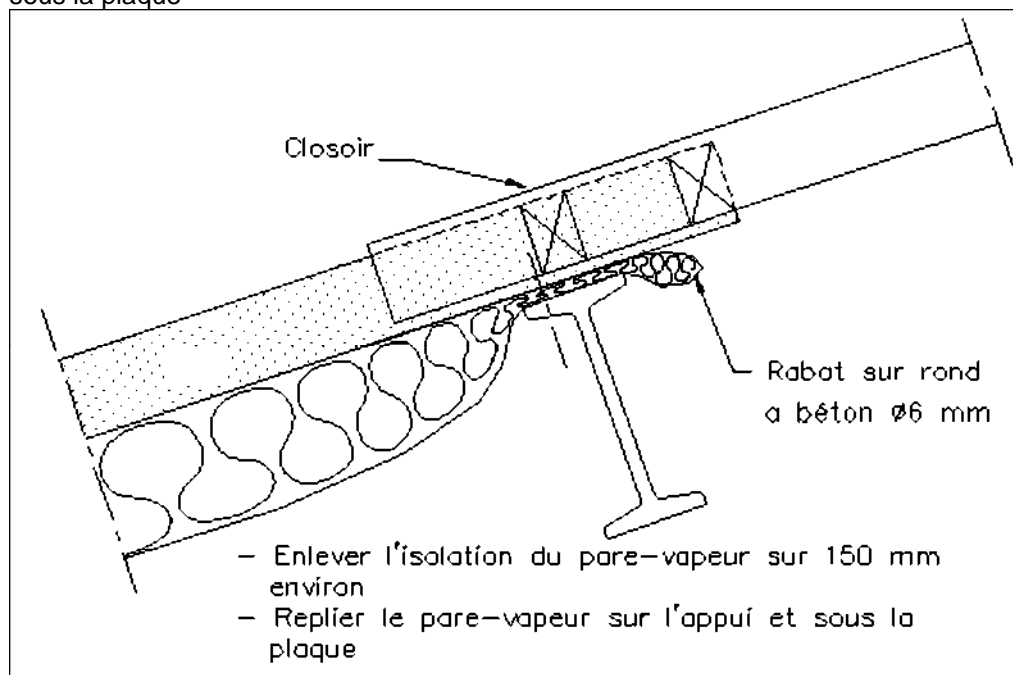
Isolation sur panne - feutre isolant déroulé sur panne Recouvrement transversal sur plaque éclairante (exemples)/Variante 3 voir variante 2 avec closoir métallique
